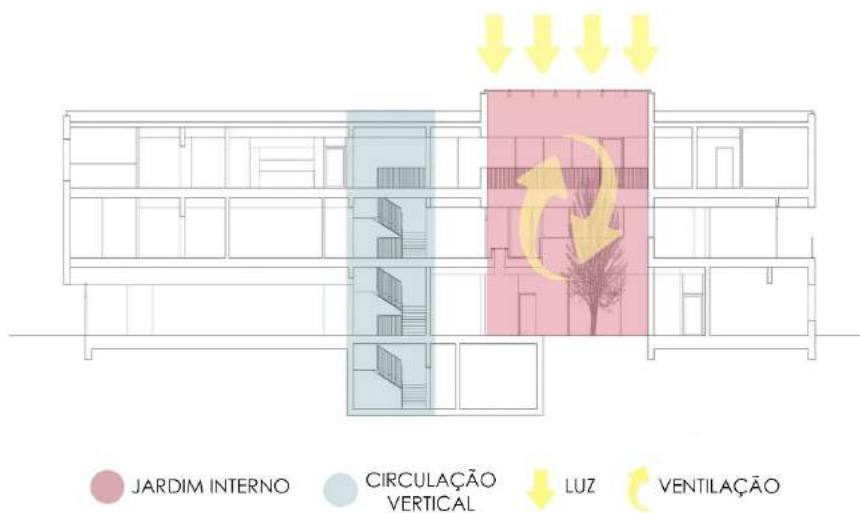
Corte esquemático. Fonte: Archdaily.
